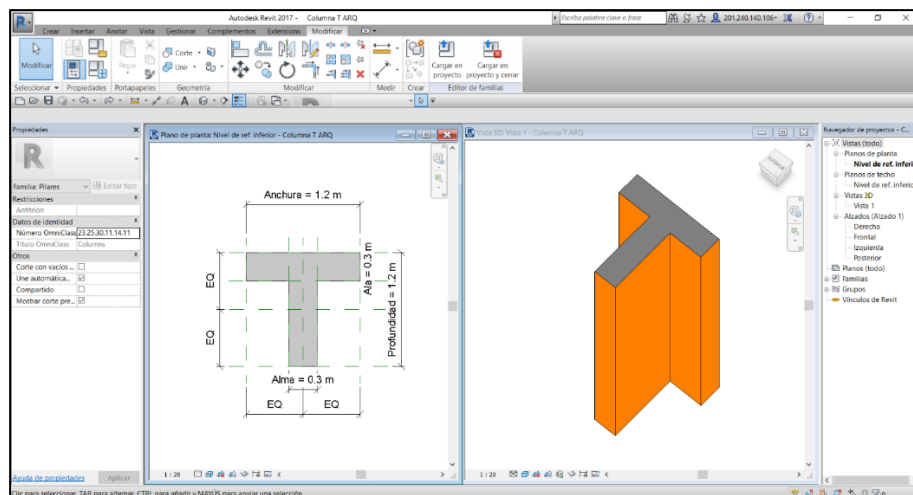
Modelo paramétrico de una columna T, área de estructuras del MODULO 01 en Revit
